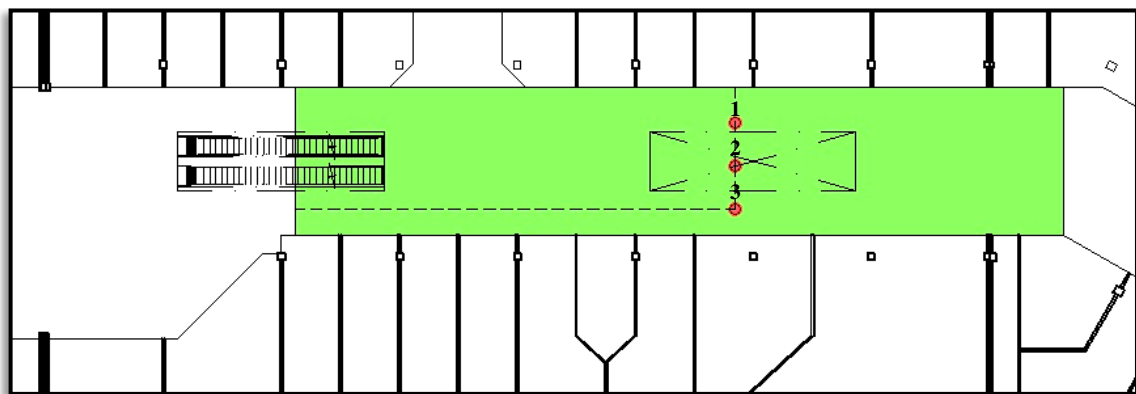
Localização dos pontos de medição no primeiro pavimento.
